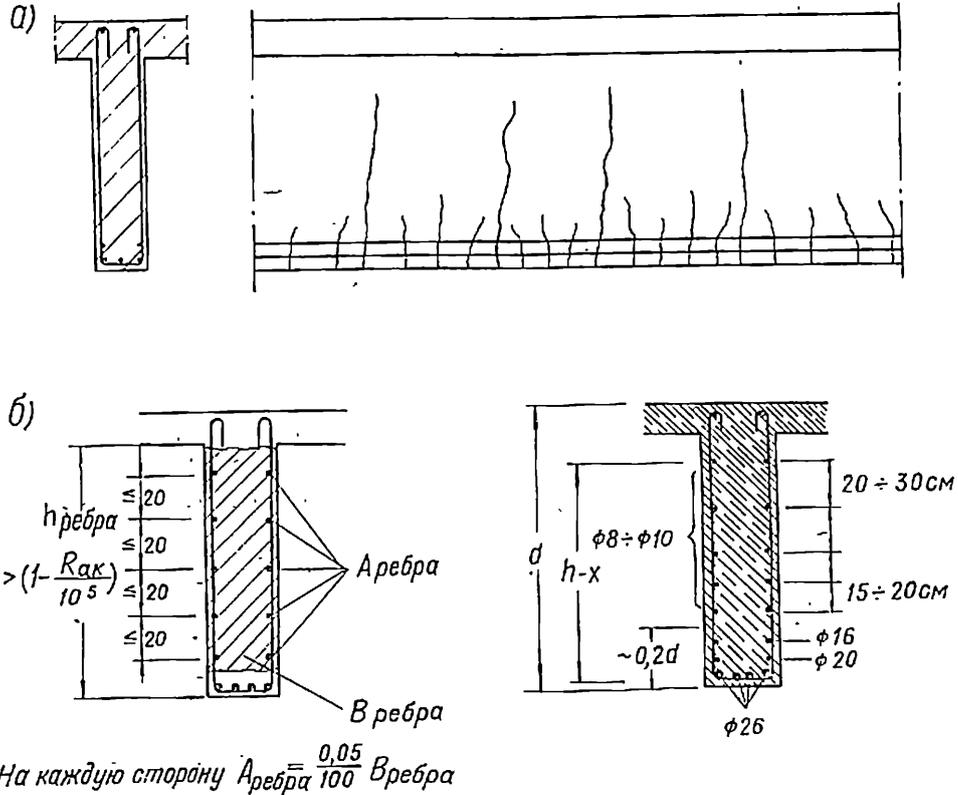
5. Значительных трещин в высоком ребре (а) можно избежать путем дополнительной укладки продольных стержней (б)
